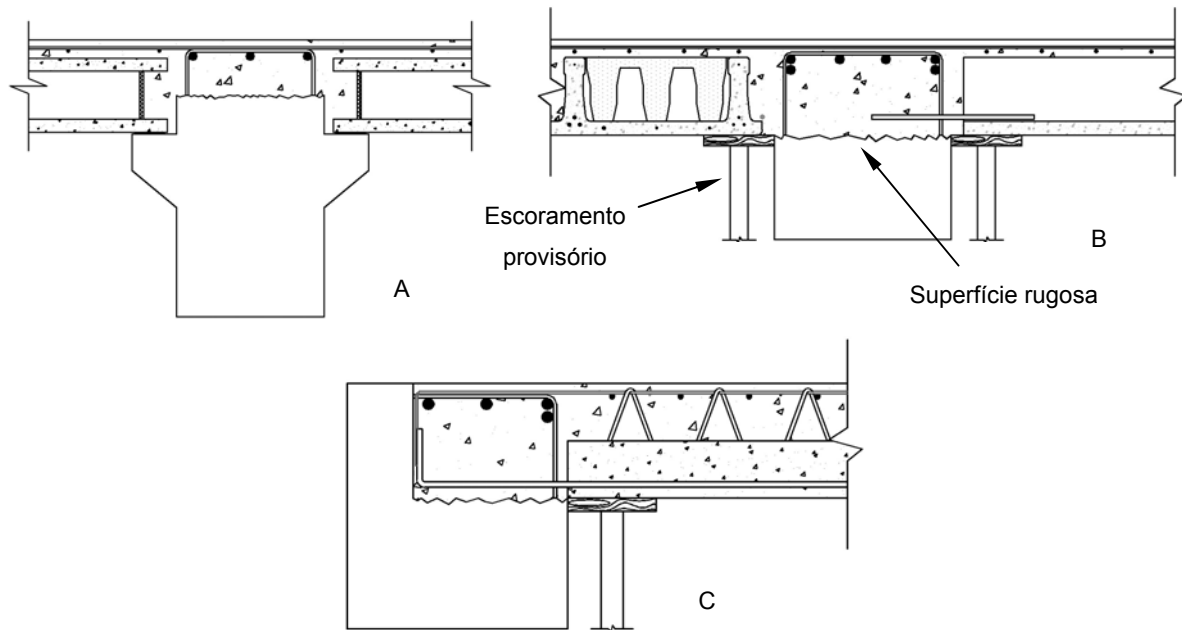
Ligações laje – viga, A – laje alveolar, B – laje minos, C – pré-laje maciça
